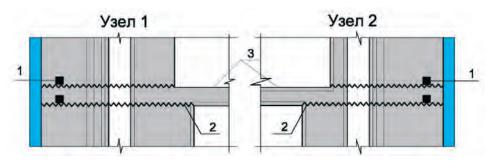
Типовые узлы гидроизоляции в машинном зале и технологических помещениях (узлы 1 и 2 на рис. 7.1.8):1 — гидроизоляционный жгут «Пенебар» и «Скоба крепежная металлическая»; 2 — шов бетонирования; 3 — железобетонное перекрытие
